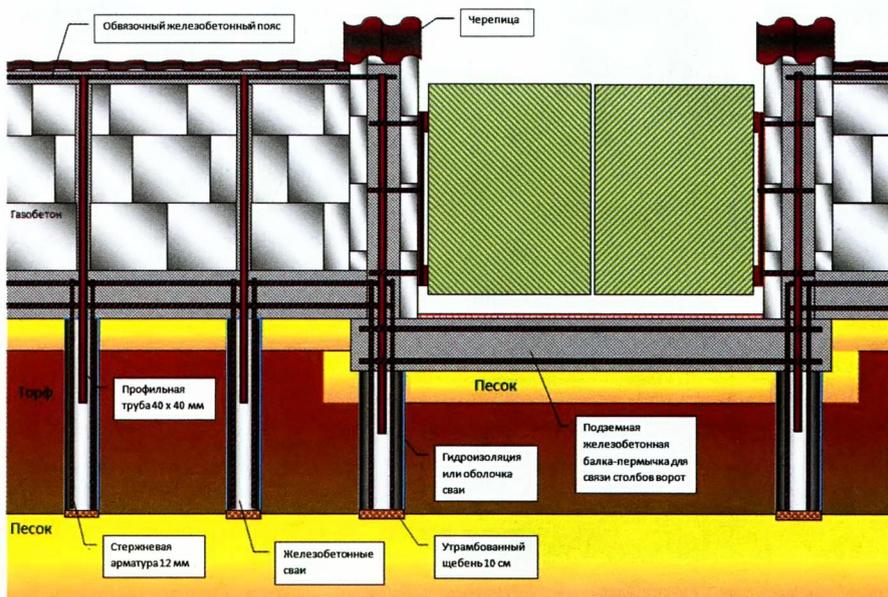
Схема армирования фундамента и столбов для ворот забора из газобетонных блоков.
